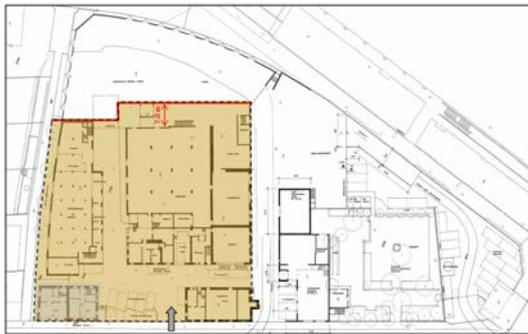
Planungsausschnitt Areal Brauerei H. Müller AG, Plangrundlage geoProRegio, Regionalwerke AG, Baden
